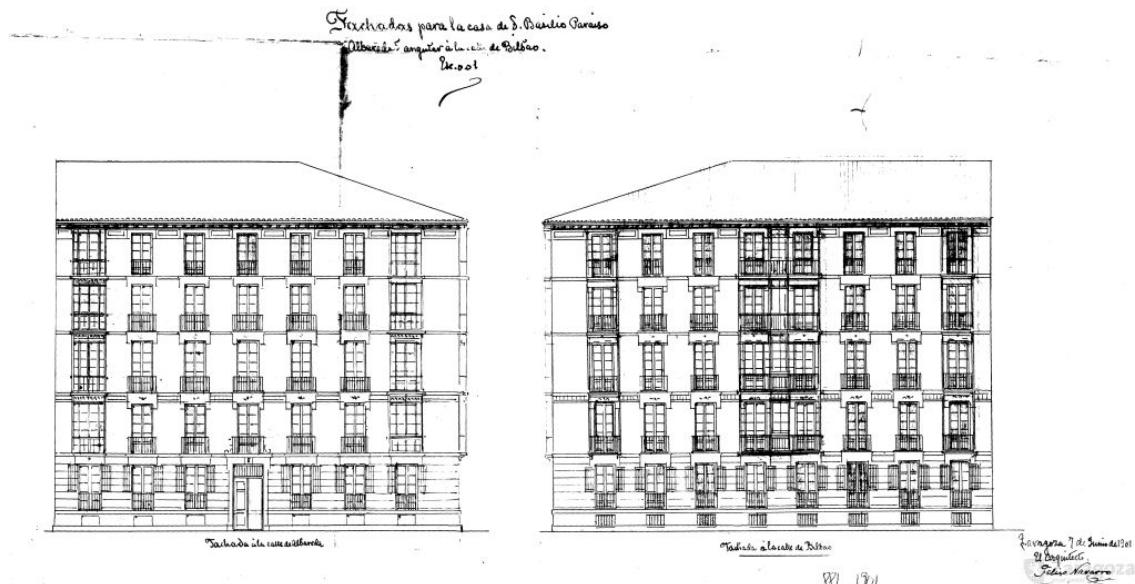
Proyecto de fachadas para el inmueble emplazado entre las calles de Albareda, núm. 7, y calle Bilbao, Zaragoza, por el arquitecto Félix Navarro, 7 de junio de 1901 (AMZ).
